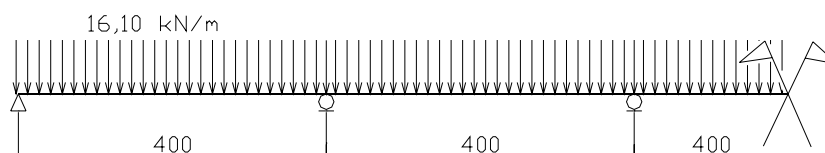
Esquema estrutural e de carregamento, Caso 1 (dimensões em cm)
